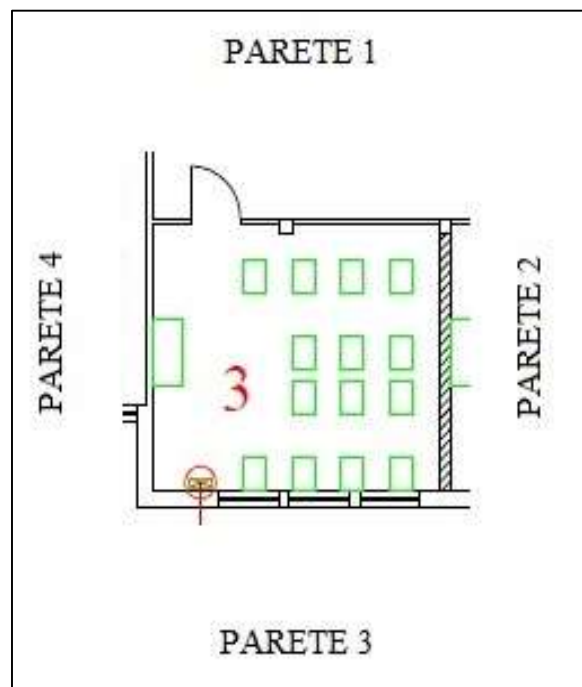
Planimetria dell'Aula 3 (2°B) oggetto di misurazioni
